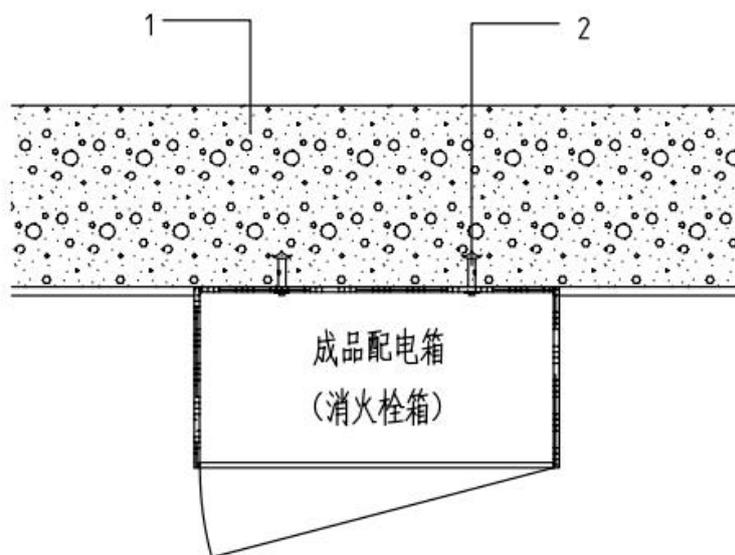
墙体安装箱子墙体示意（明装）
